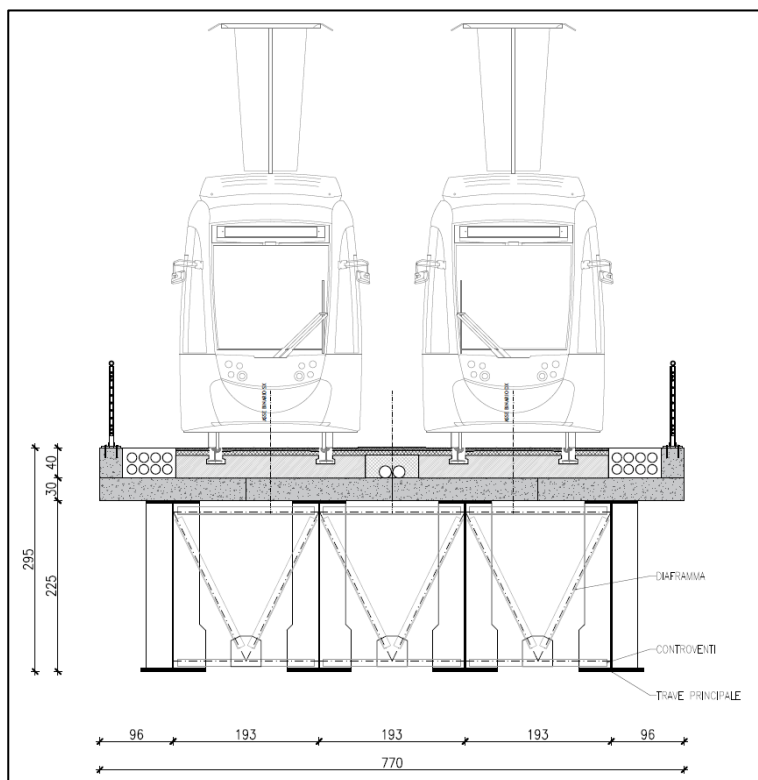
Sezione trasversale tipo dell'impalcato
